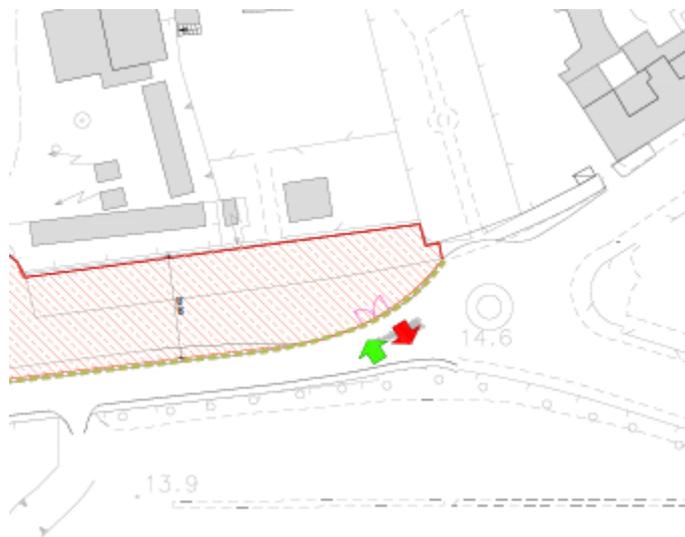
FASE 4b – Dettaglio accesso cantiere di via Plinio
